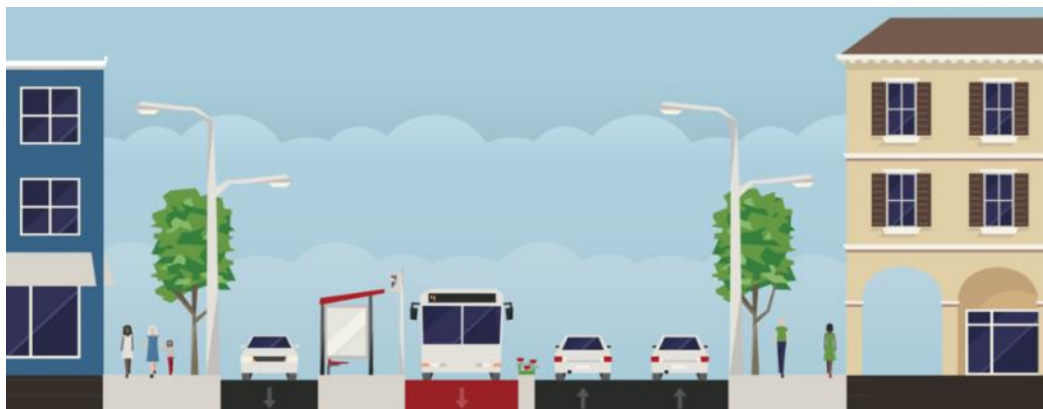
Corte trasversal propuesto para la Av. Winston Churchill con buses de acceso dual.
